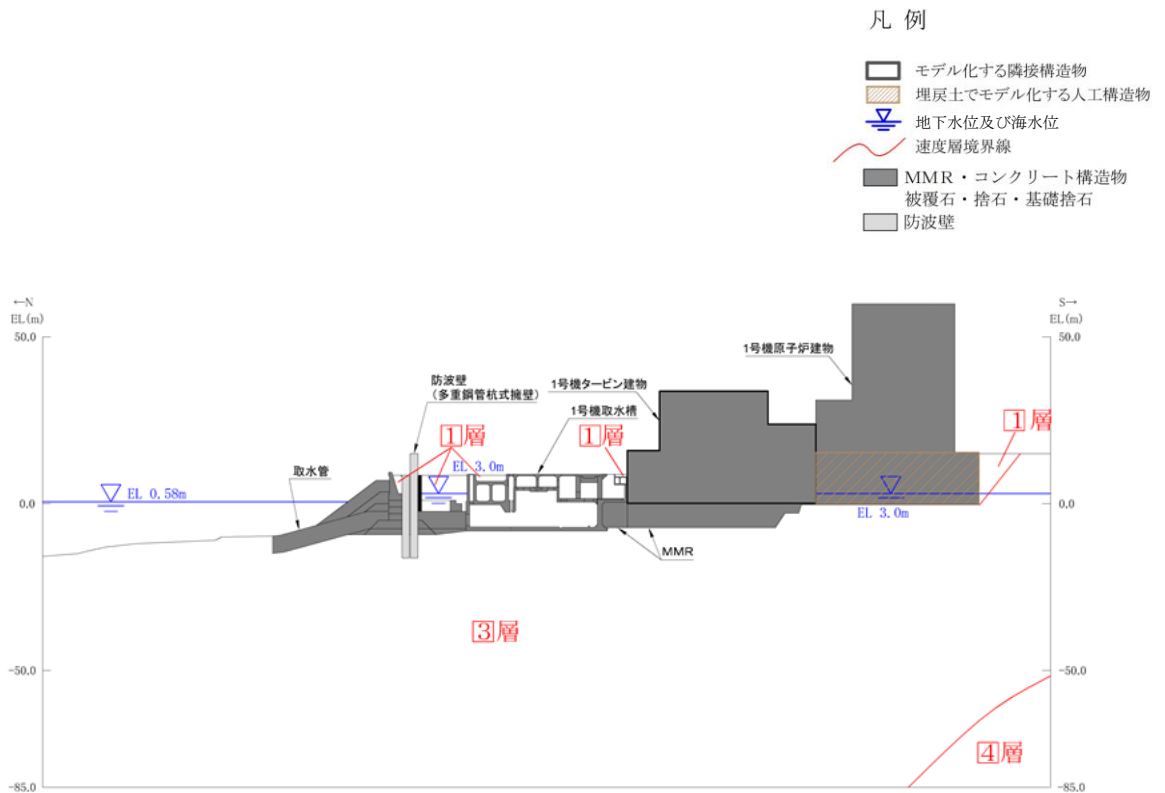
1号機取水槽 断面图(B-B断面)
